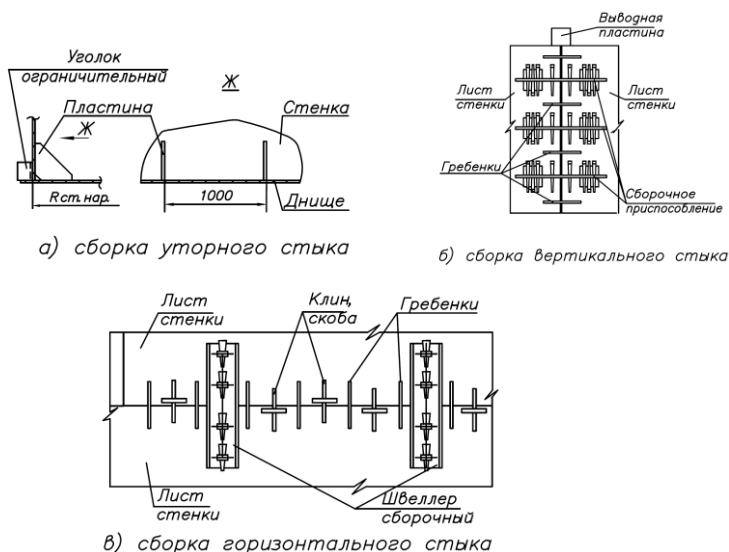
Сборка стыков листовой стенки [5]
